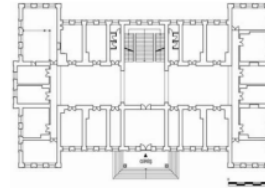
Bolu Hükümet Konağı Planı, 1881
